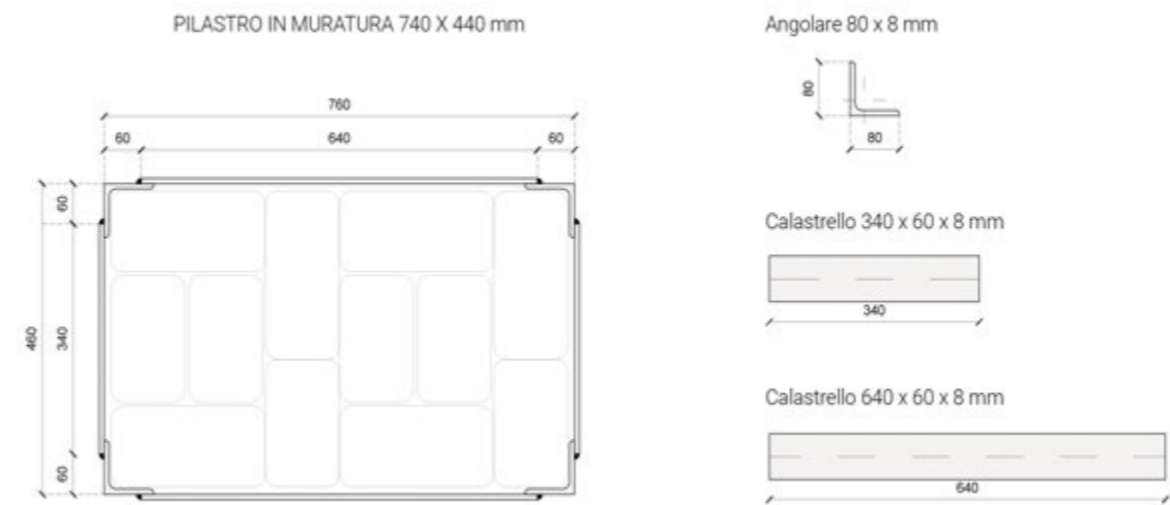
Sezione del pilastro centrale in muratura, di dimensioni maggiori, e indicazione dei relativi elementi della cerchiatura.
